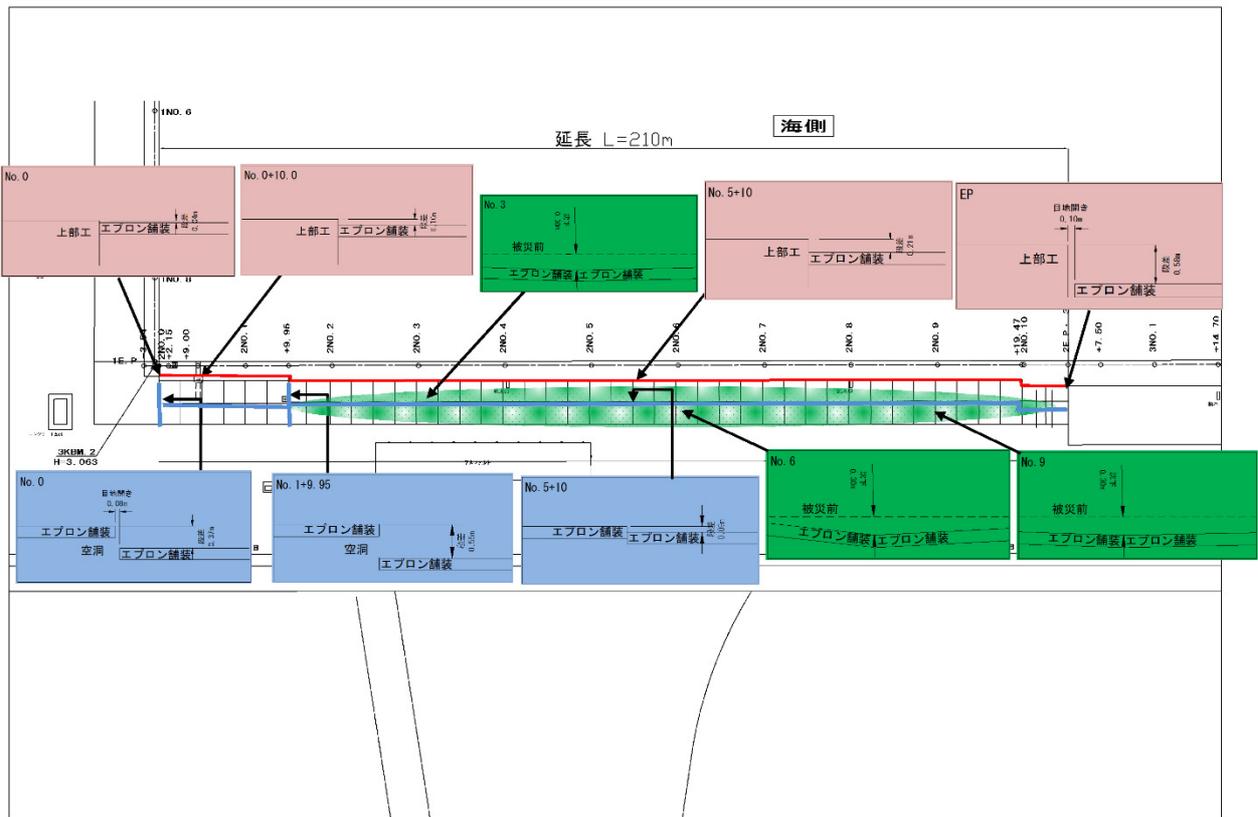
No.22 常陸那珂港区_南埠頭地区 B岸壁 (-5.5m) の平面図 (被災後)
